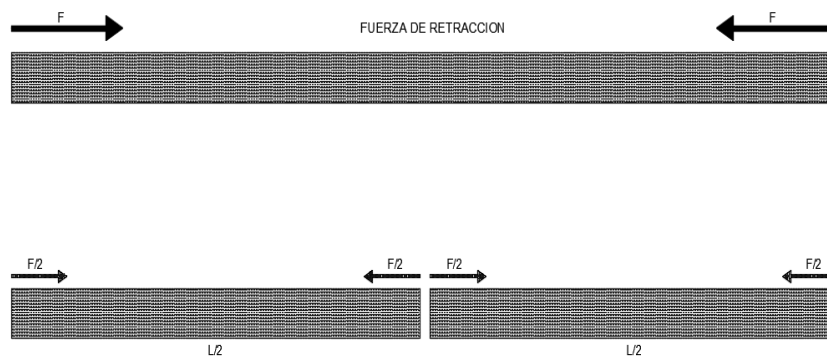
Factores que afectan el comportamiento en las losas de un pavimento Fuente: TCPavements (innovación en pavimentos).
